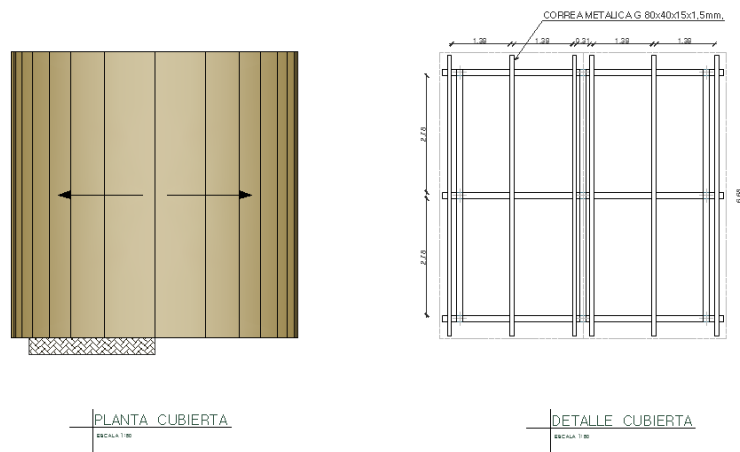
Detalle constructivo Cubierta - Vivienda Rural MIDUVI
